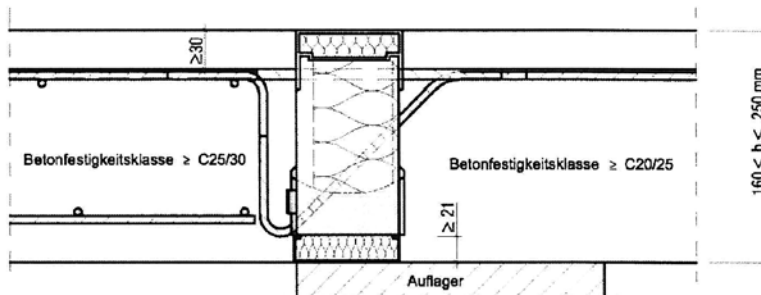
Beispiel Schöck Isokorb in eingebautem Zustand
